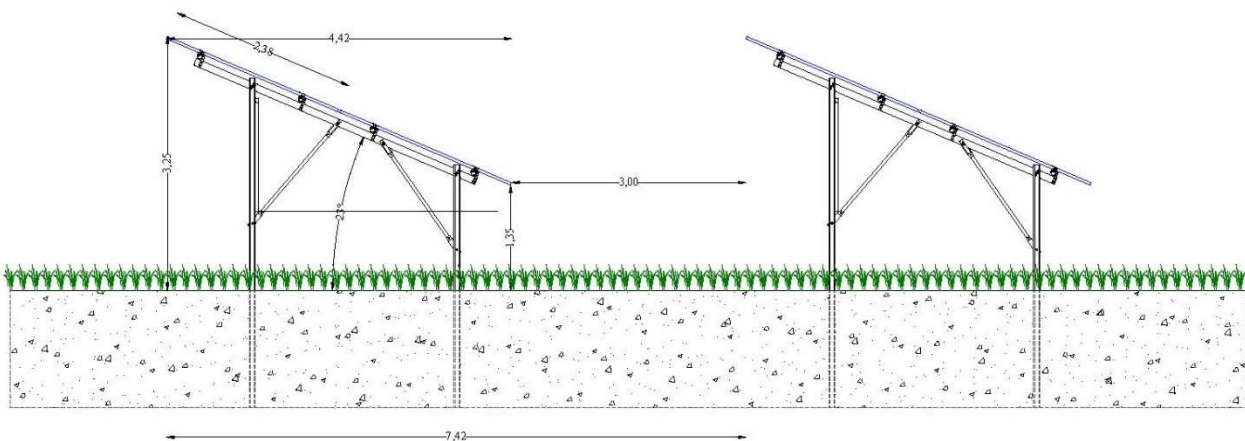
Struttura di ancoraggio Azimut 0° Tilt 23°. Le strutture di sostegno saranno realizzati con profilati in acciaio
